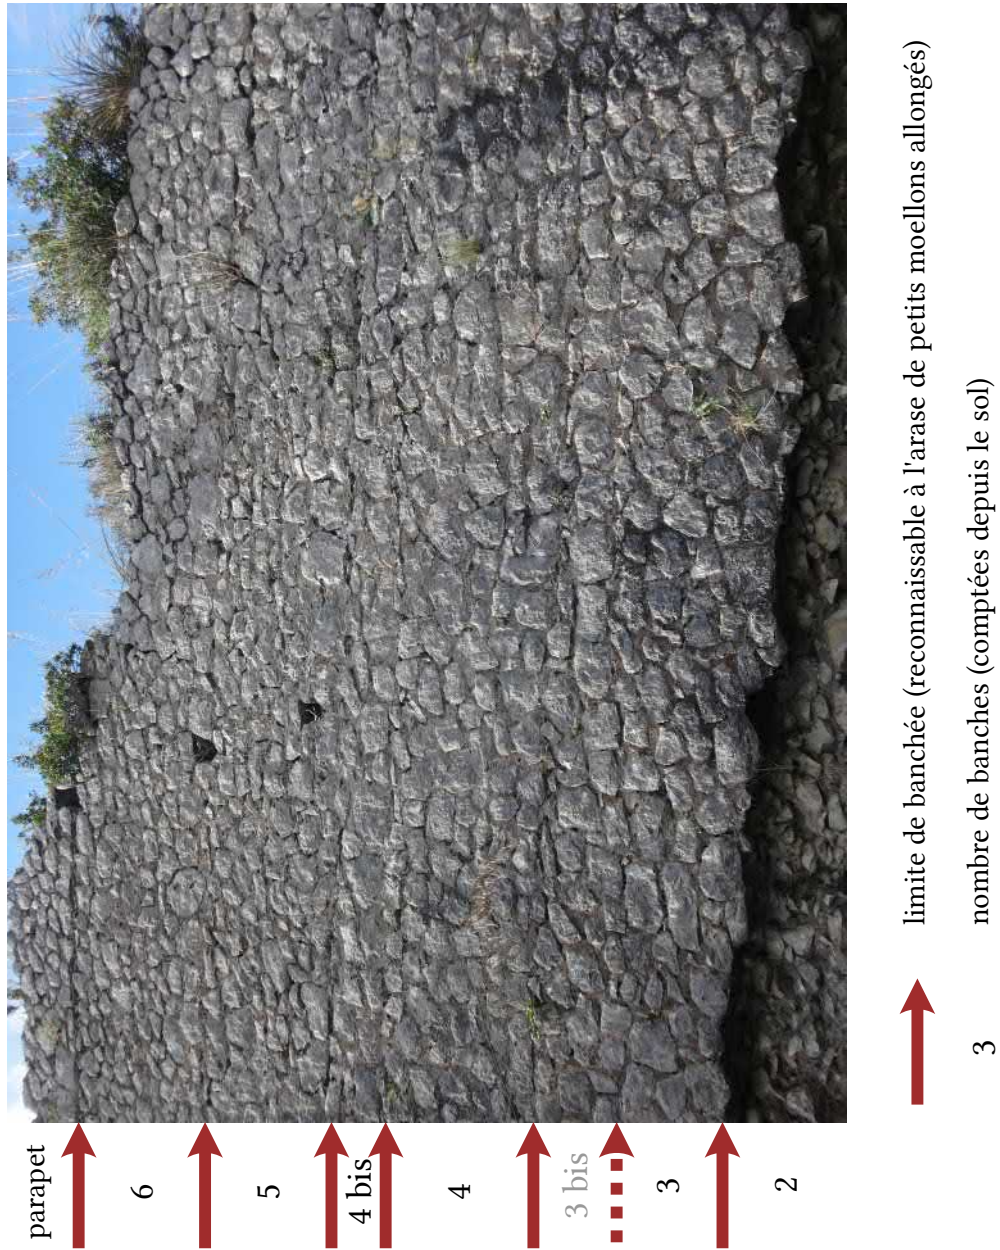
La muraille de Terracine : raccord entre deux équipes de travail
